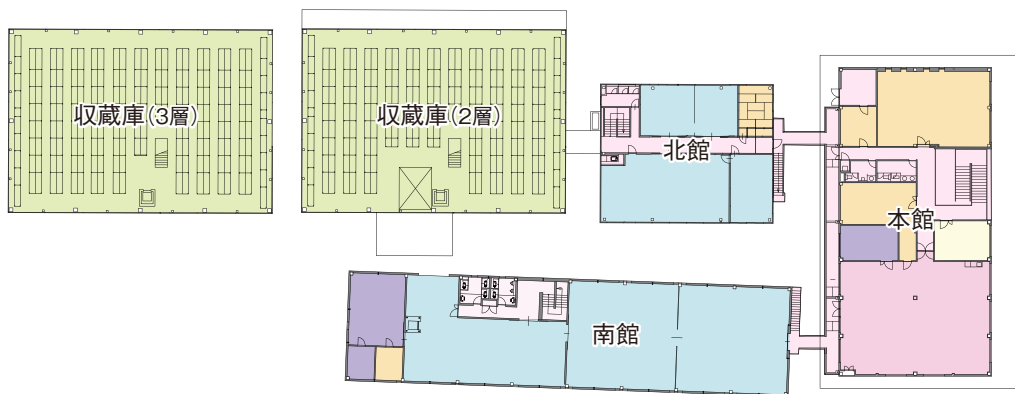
高知県立埋蔵文化財センター 2F 平面図(S=1/800)
